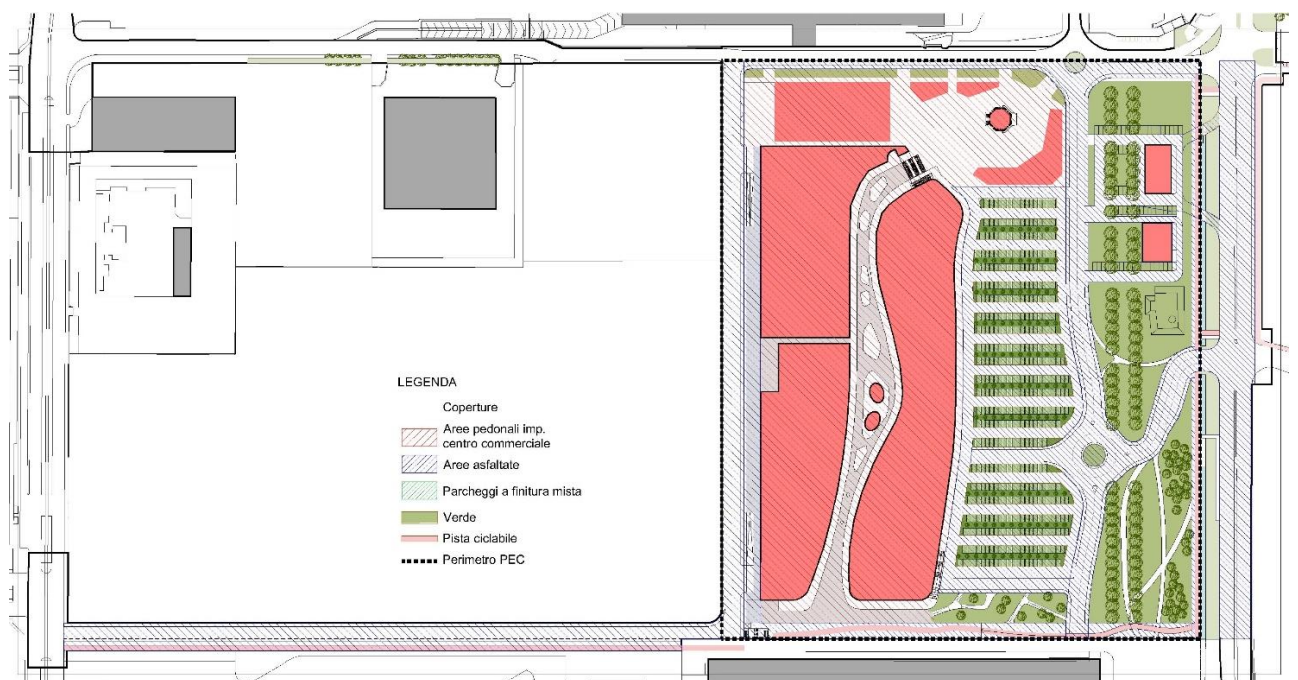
planimetria area PEC con suddivisione delle superfici per tipologia
